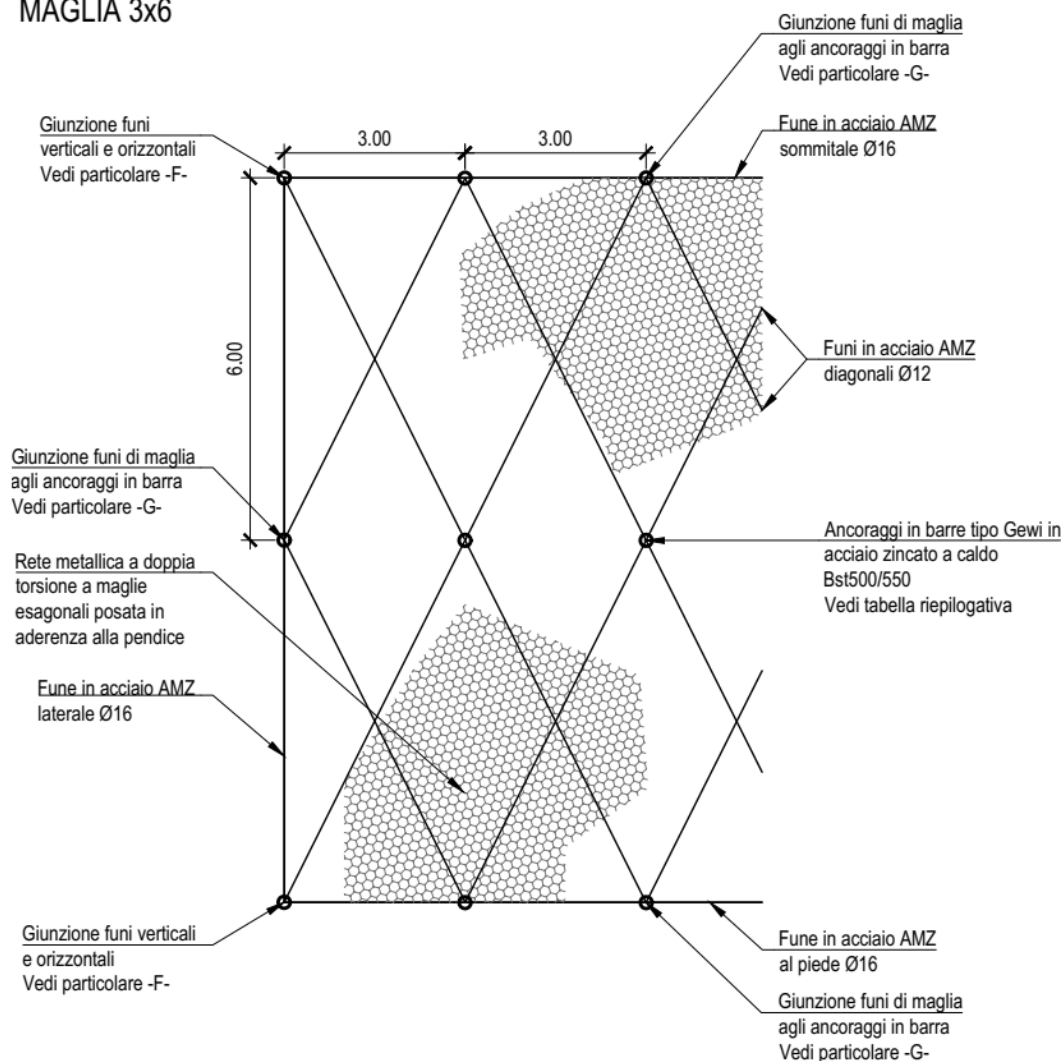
Prospetto tipologico del rafforzamento corticale con maglia di ancoraggi rettangolare 3x6 m
